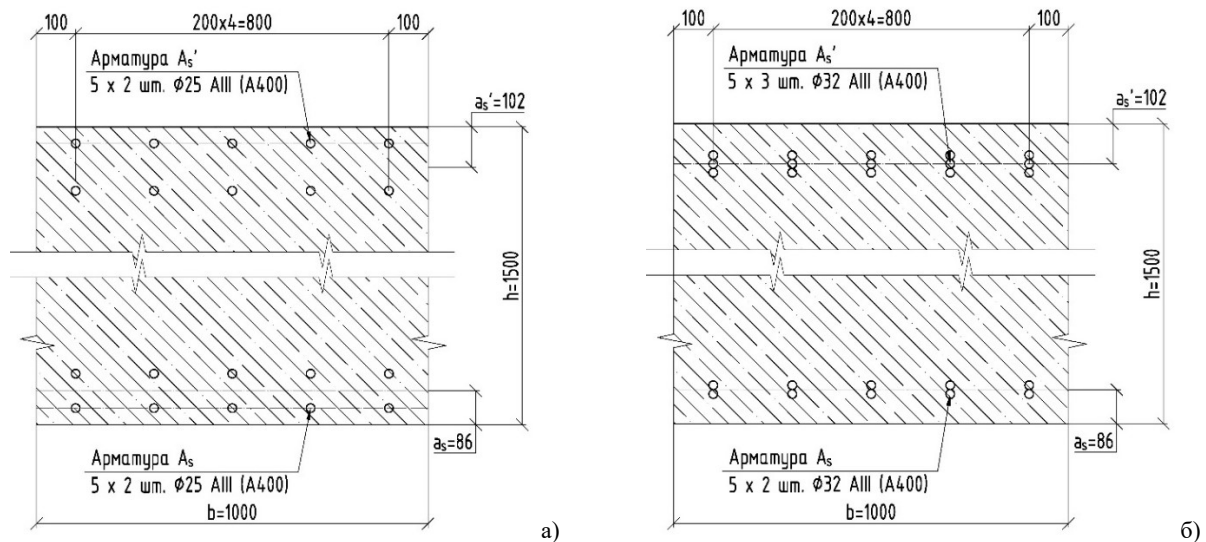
Визначене за розрахунком армування 1 м.п. ригеля опори шляхопроводу по осі «7»: а – армування по 0х (поперек осі ригеля, вздовж шляхопроводу), б – те саме у робочому напрямку, вздовж ригеля.
